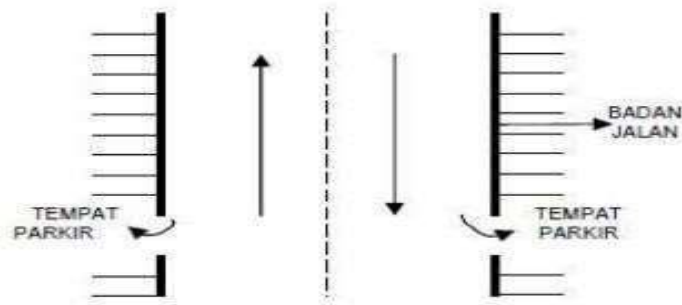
Fasilitas Parkir dibadan jalan.
